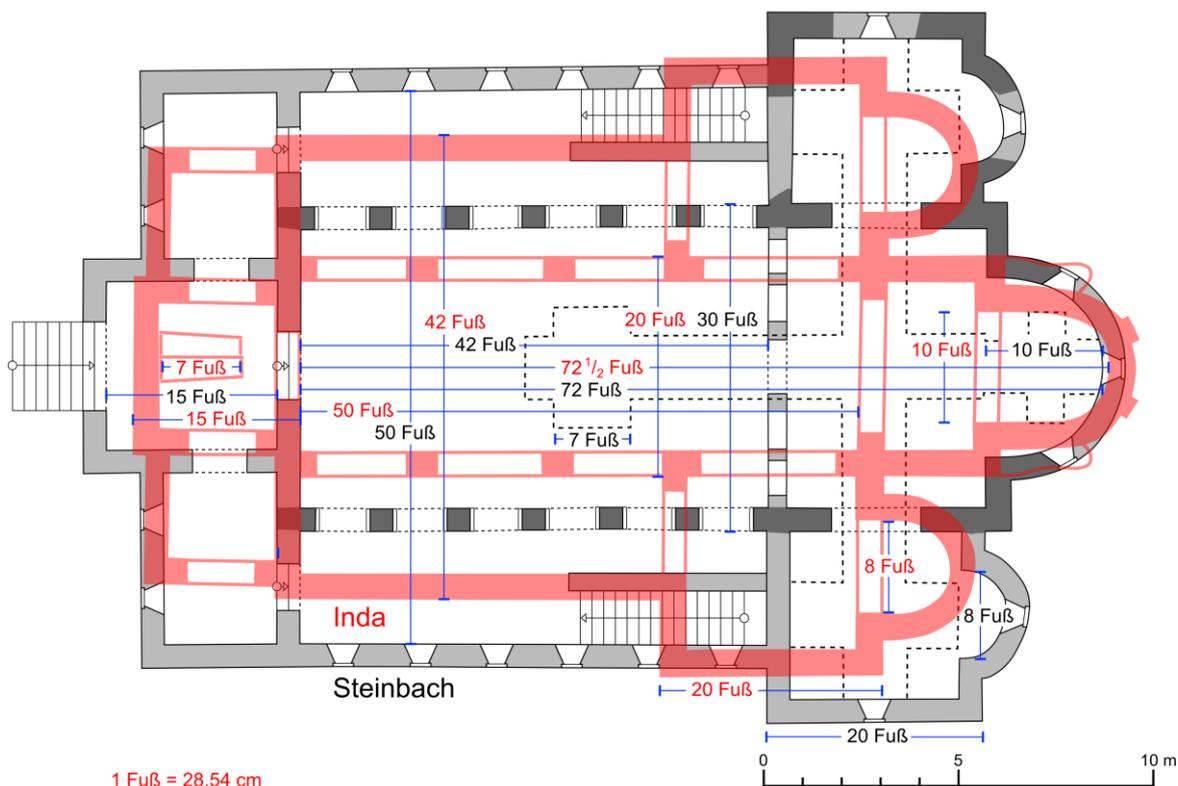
Vergleich der Grundrisse von Steinbach und Inda
